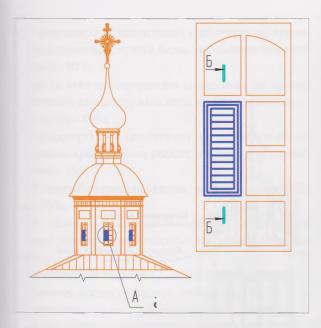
Фрагмент западного фасада с обратными воздушными клапанами (A)
